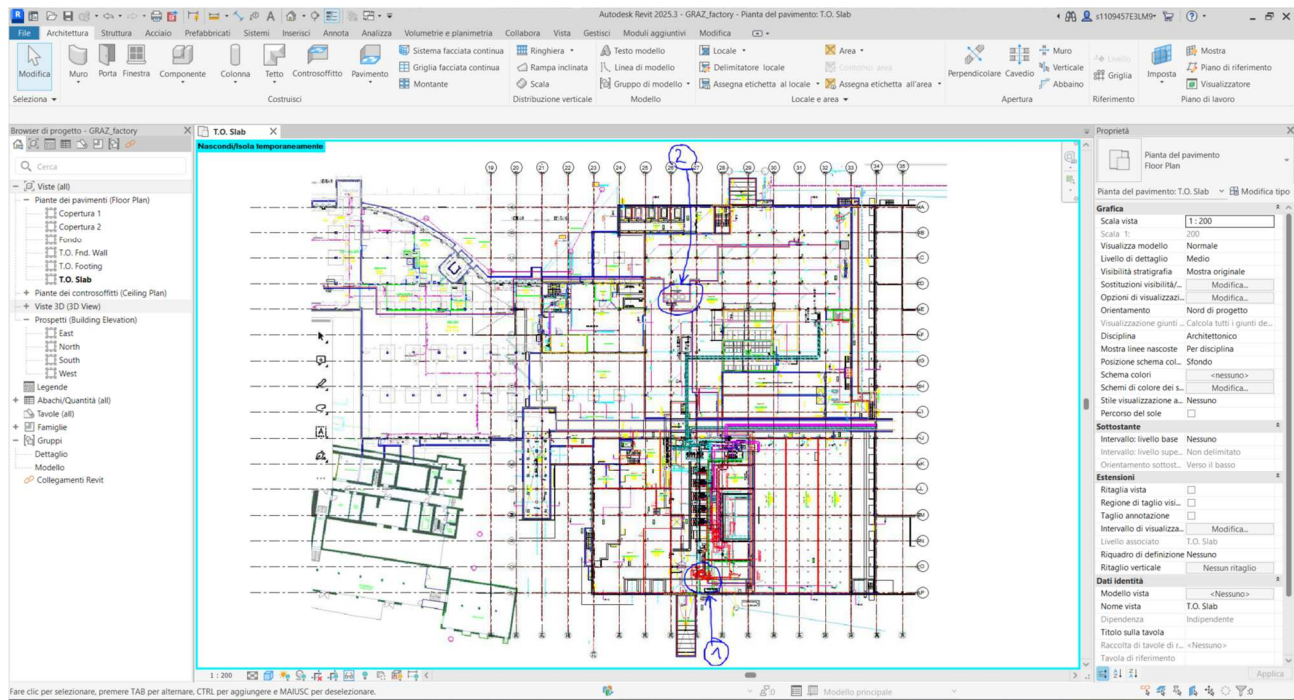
Layout di Revit con pianta di piano dell'edificio e griglia di riferimento
